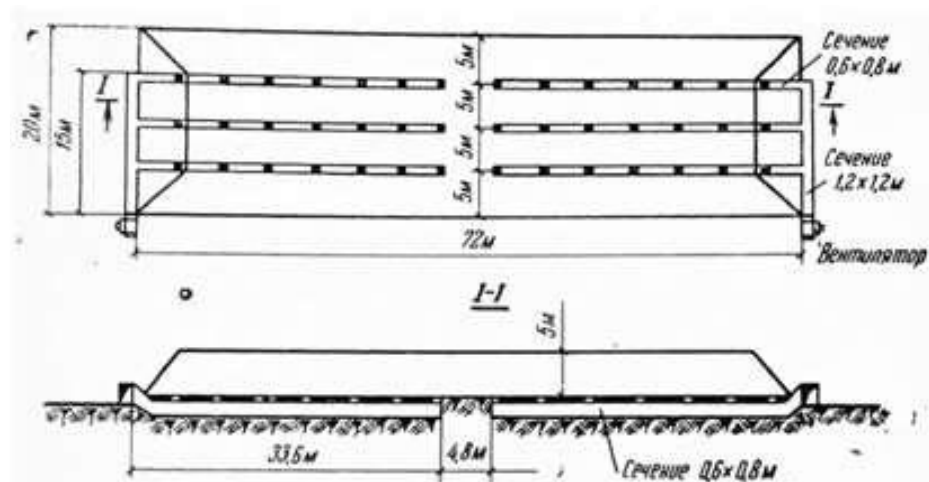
Поздовжня схема вентиляції розташування вентиляційних гілок
